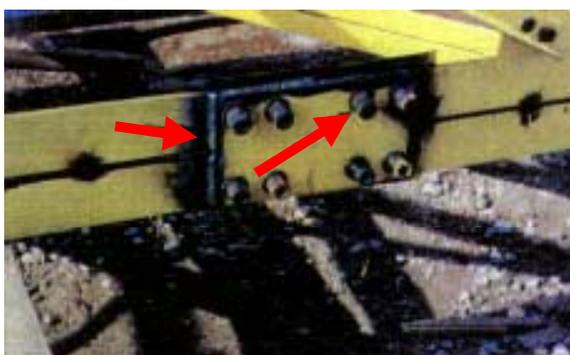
Ligação indefinida: soldada ou parafusada? – SANTOS⁶²
